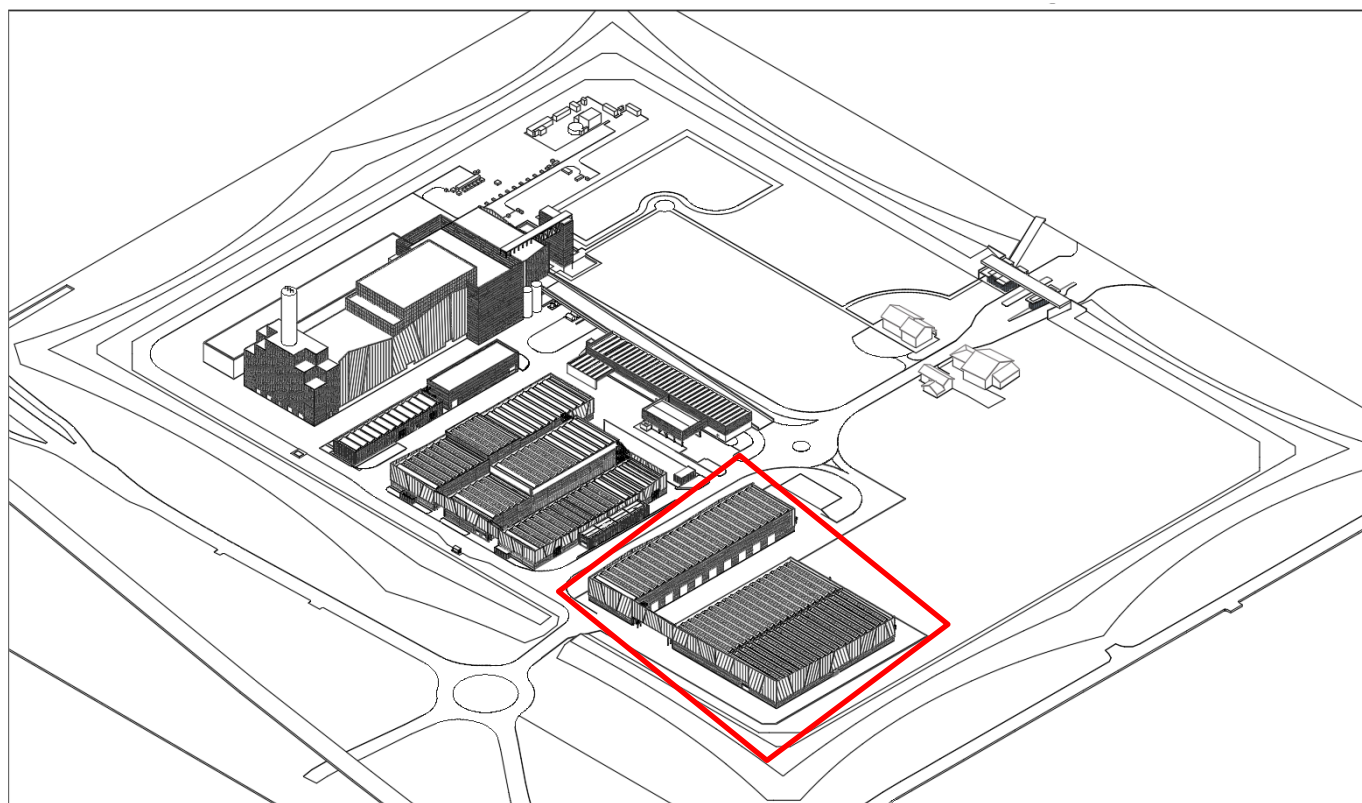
Stralcio planimetria in progetto. Nel rettangolo rosso è compresa l'area di intervento. Da doc. progettuale A.04.
